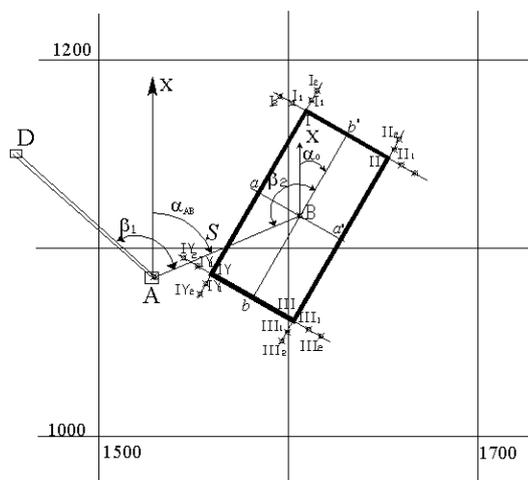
Пояснительная схема к проекту разбивки здания на промышленной площадке карьера.
